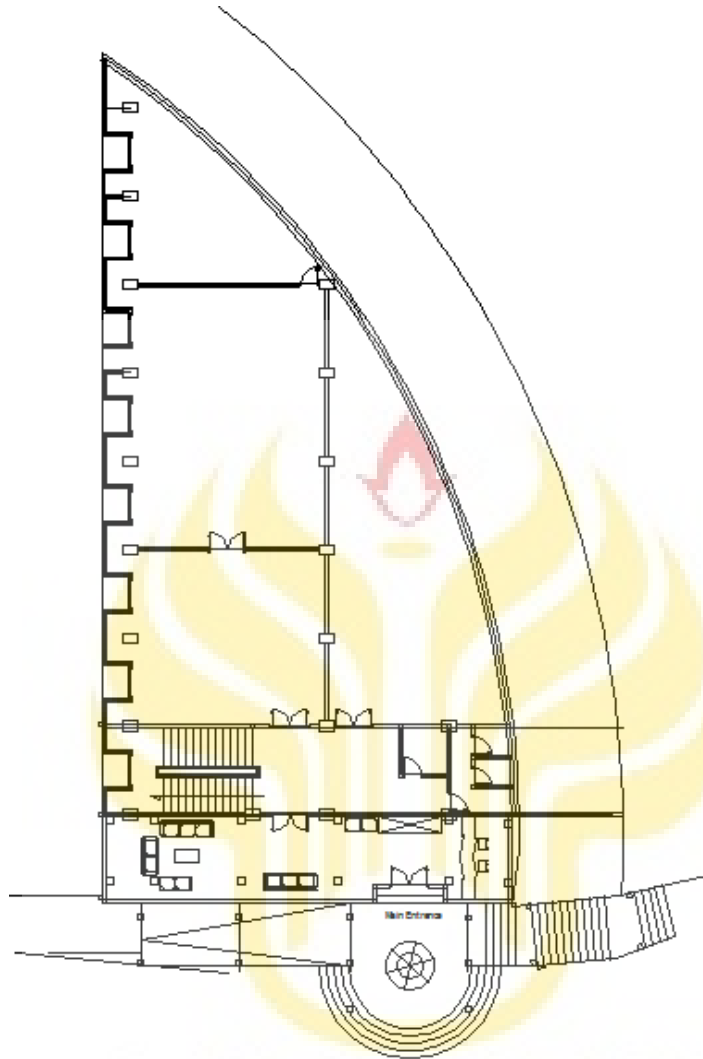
Siteplan Museum Sangiran Klaster Krikilan
